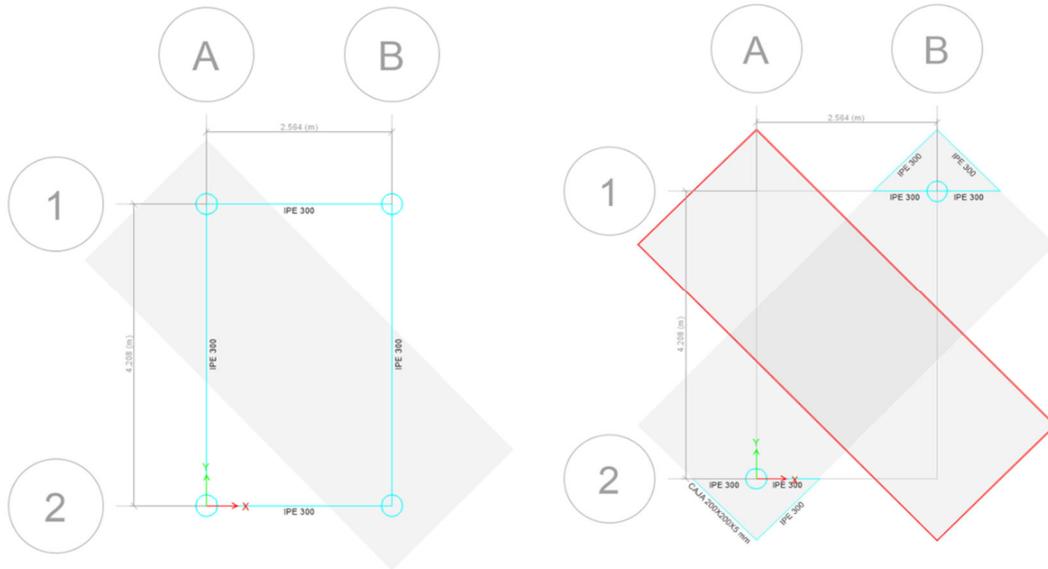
Secciones de acero por vigas de planta alta y segundo nivel.
